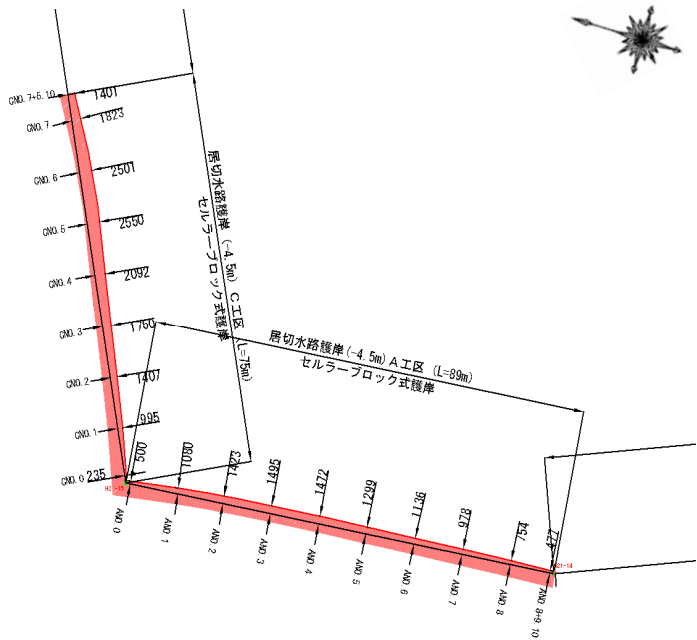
121 No. 3 居切導水路A岸壁の平面図
